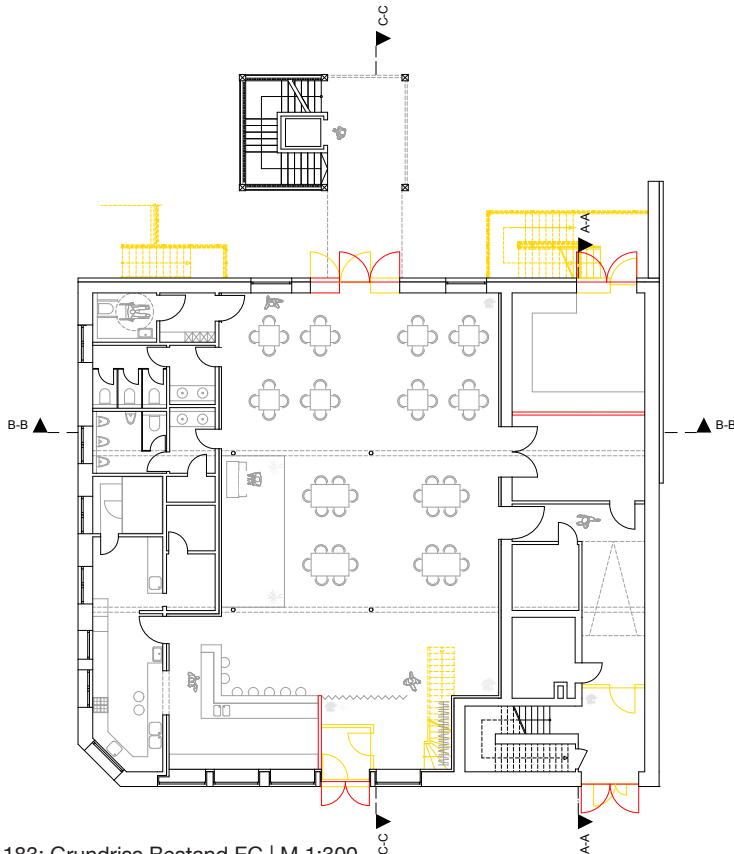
Grundriss Bestand EG | M 1:300
